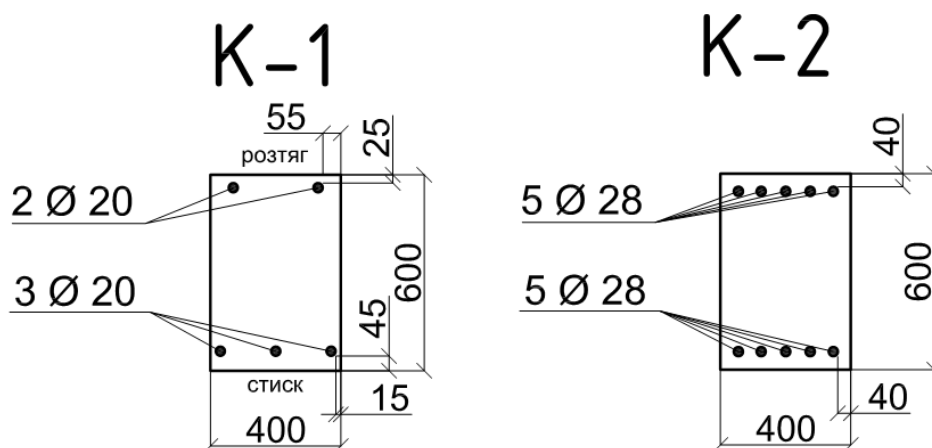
Схема армування колон К-1 та К-2 Круп'яного цеху під літ. «К»
